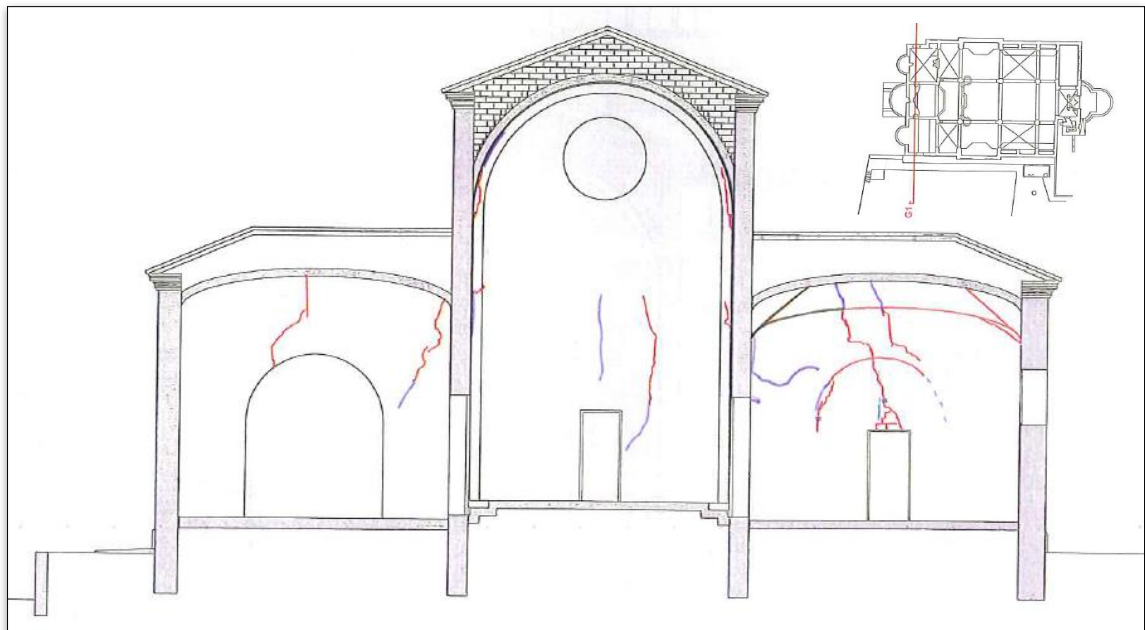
Grietas sección transversal norte 2 (plano PAT. 10)
